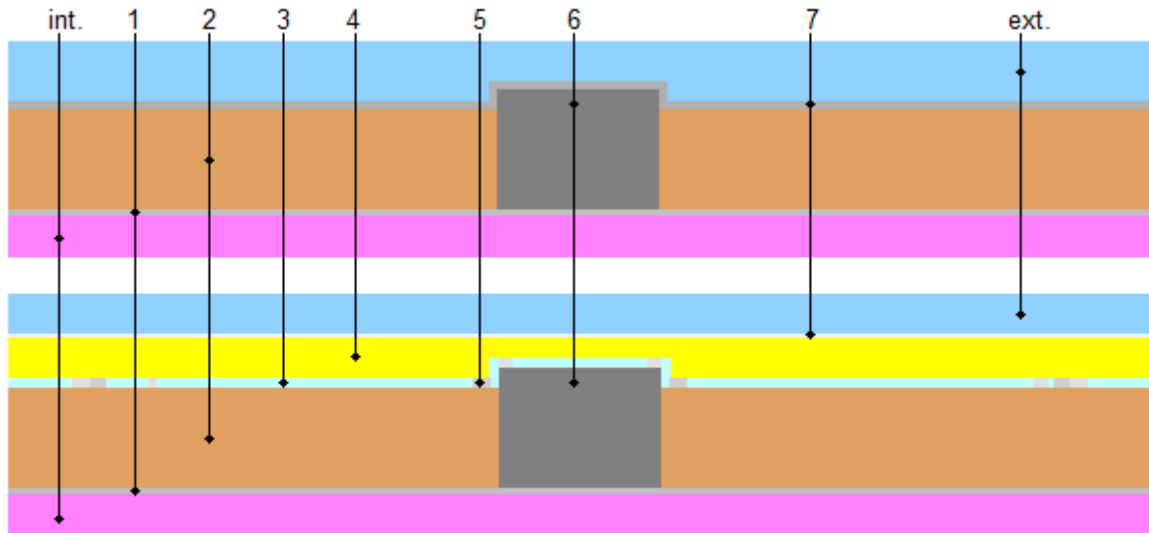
Perete exterior cu stâlp de beton armat de 30x40 cm
